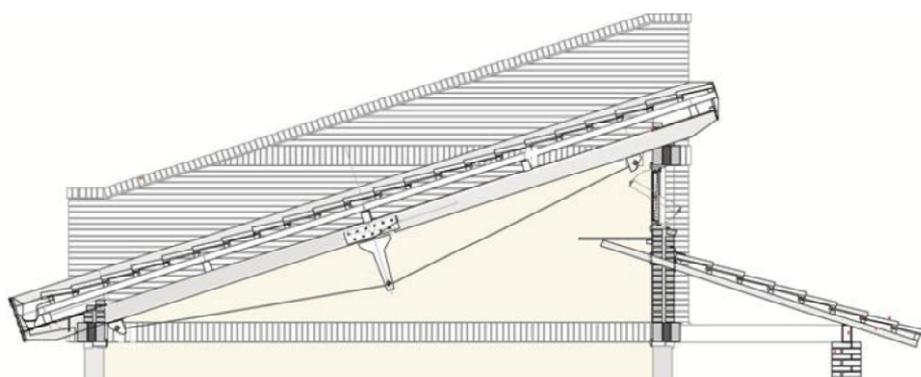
Corte transversal do telhado sul e norte, IFRS Campus de Feliz.
